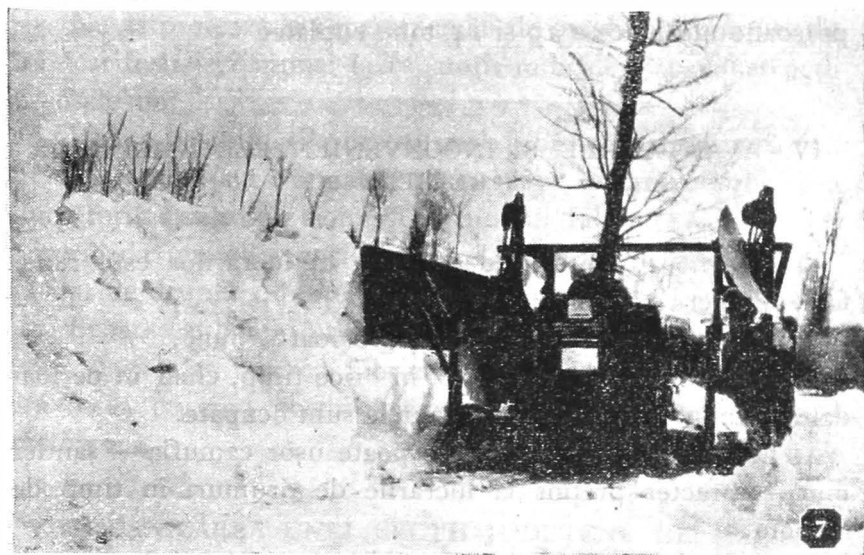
Plug de zăpadă cu tractor de 50 HP (foto. după catalog)
